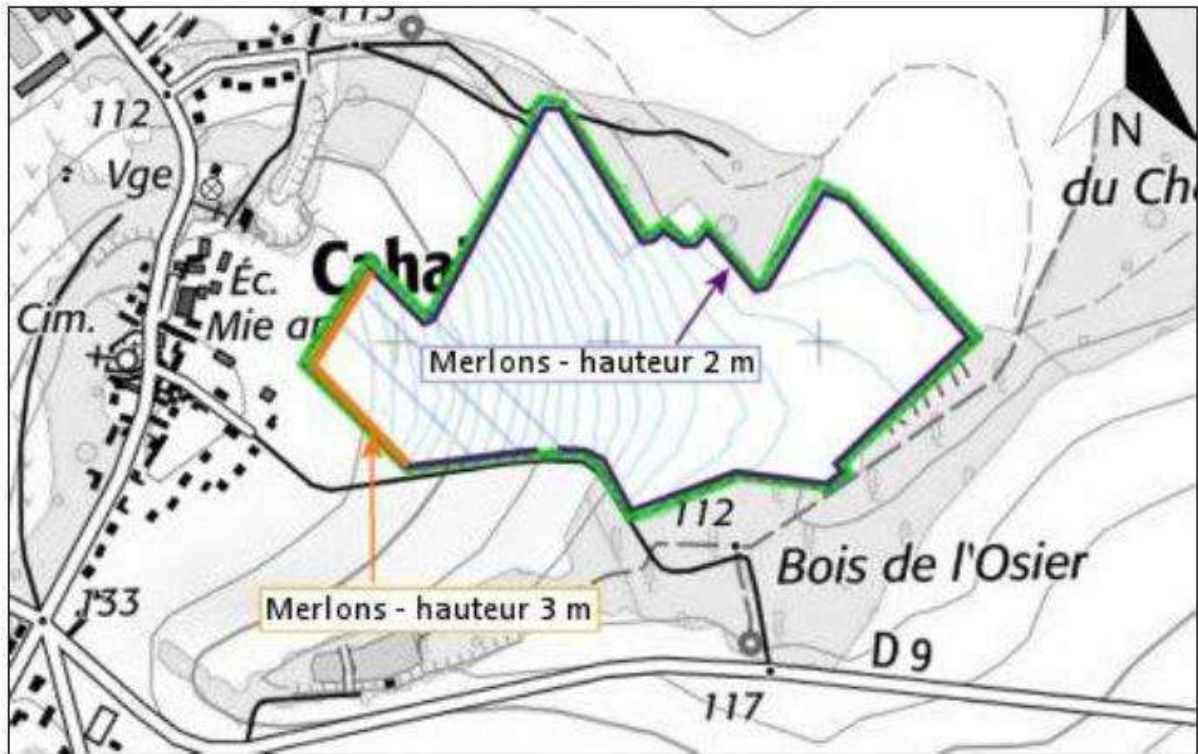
Position du merlon de 3 m à mettre en place sur le site (Source : Technisim)
